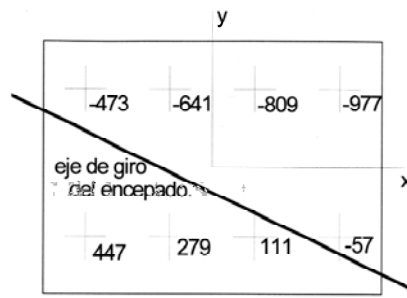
Distribución de cargas por pilote, con reparto rígido.
